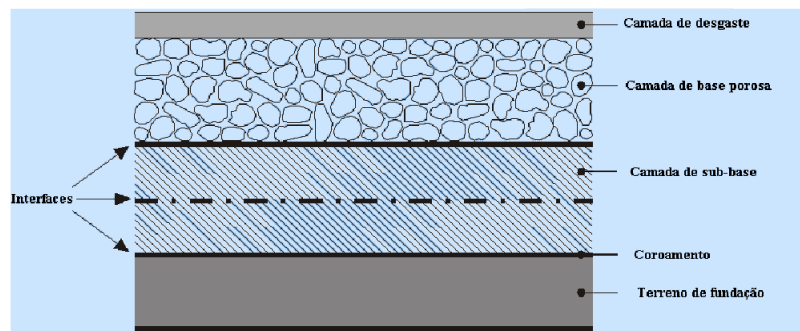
Esquema pavimento permeável (retirado de Matos, 2008).
